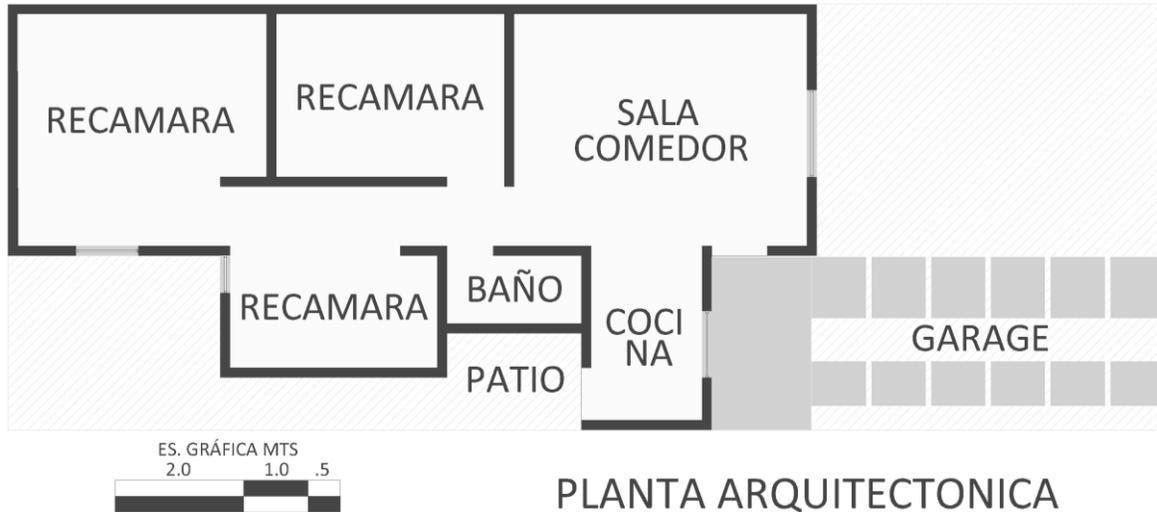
Planta Arquitectónica Pilares. Fuente: Dibujo propio en base al proyecto del Fraccionamiento.
